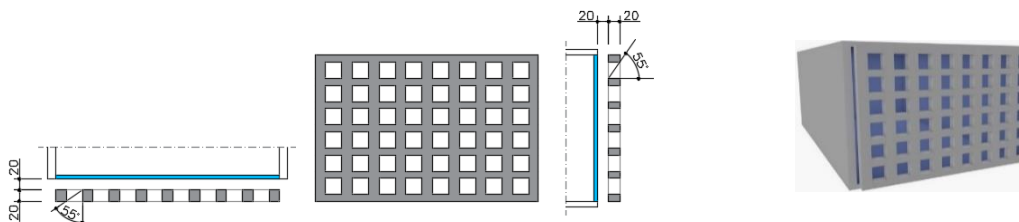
Planta baixa, vista, corte e perspectiva esquemáticos do Modelo II
